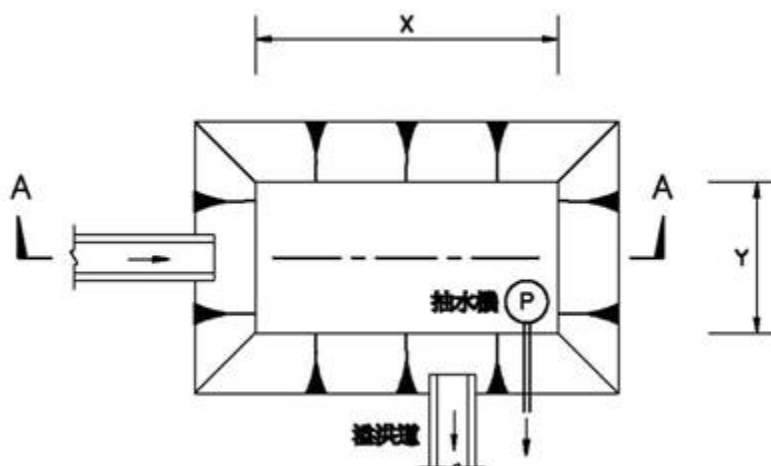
施工中滯洪沉砂池平面圖(抽水式)
